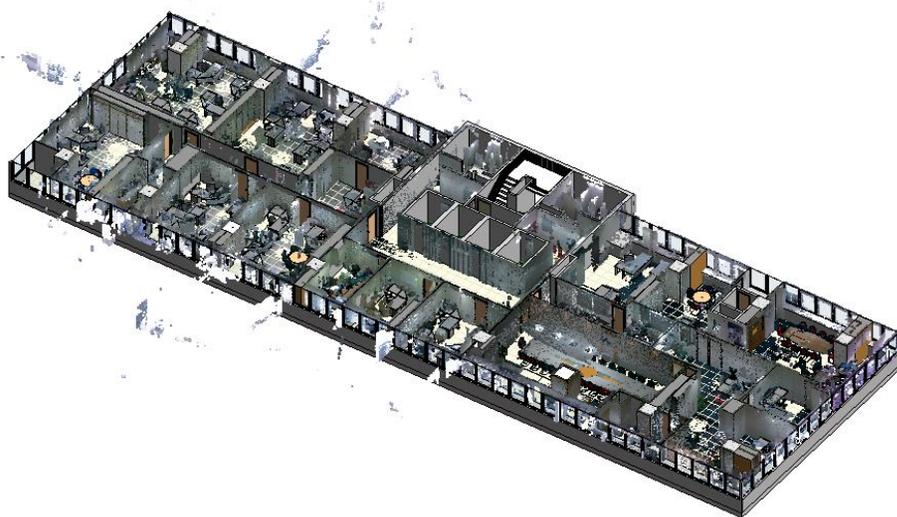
Vista 3D do pavimento tipo com nuvem de pontos
